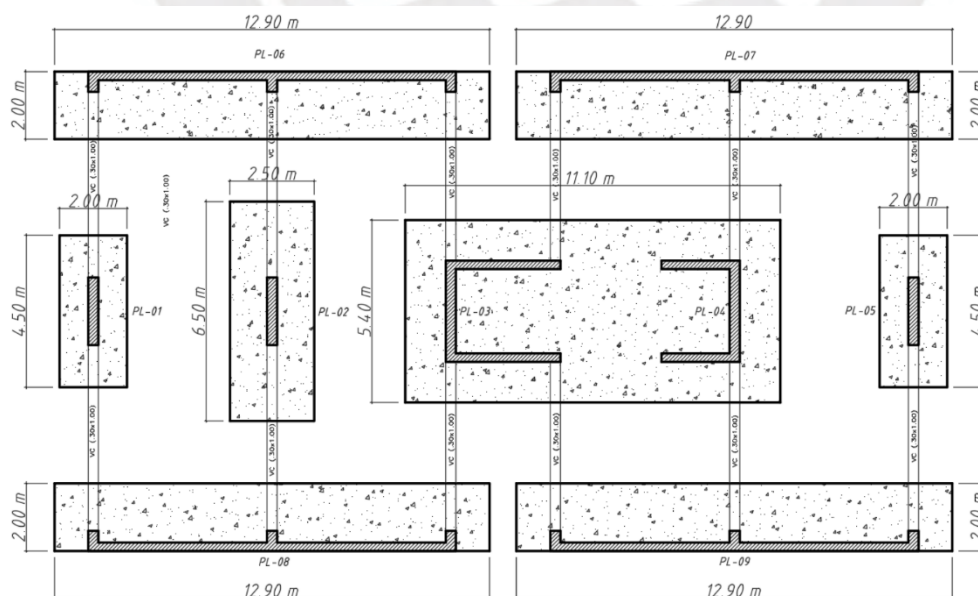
Dimensiones de las zapatas con vigas de cimentación
